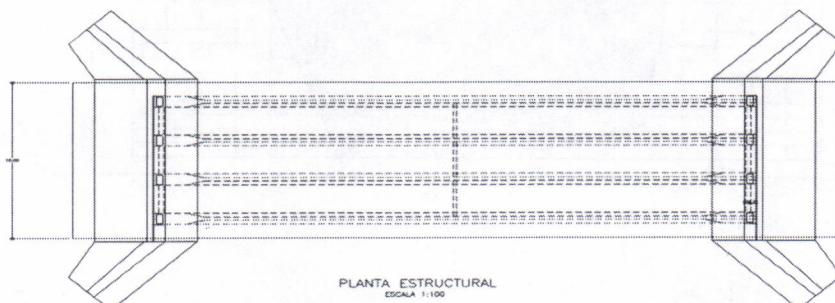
Imagen Planos Planta estructural del Puente sobre la Quebrada Moreno
